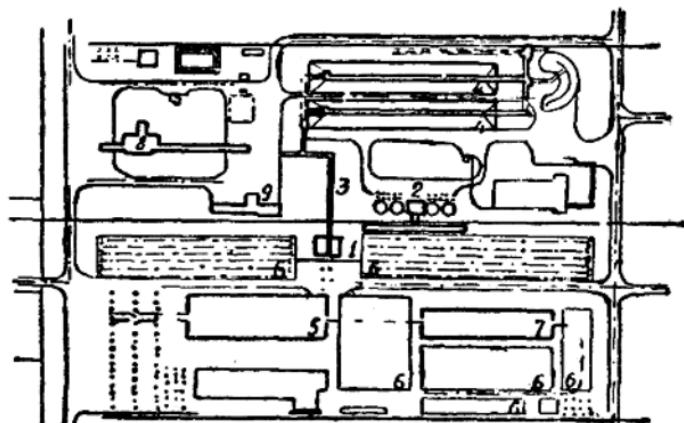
混凝土、砂浆和钢筋混凝土制品工廠总平面示意图
